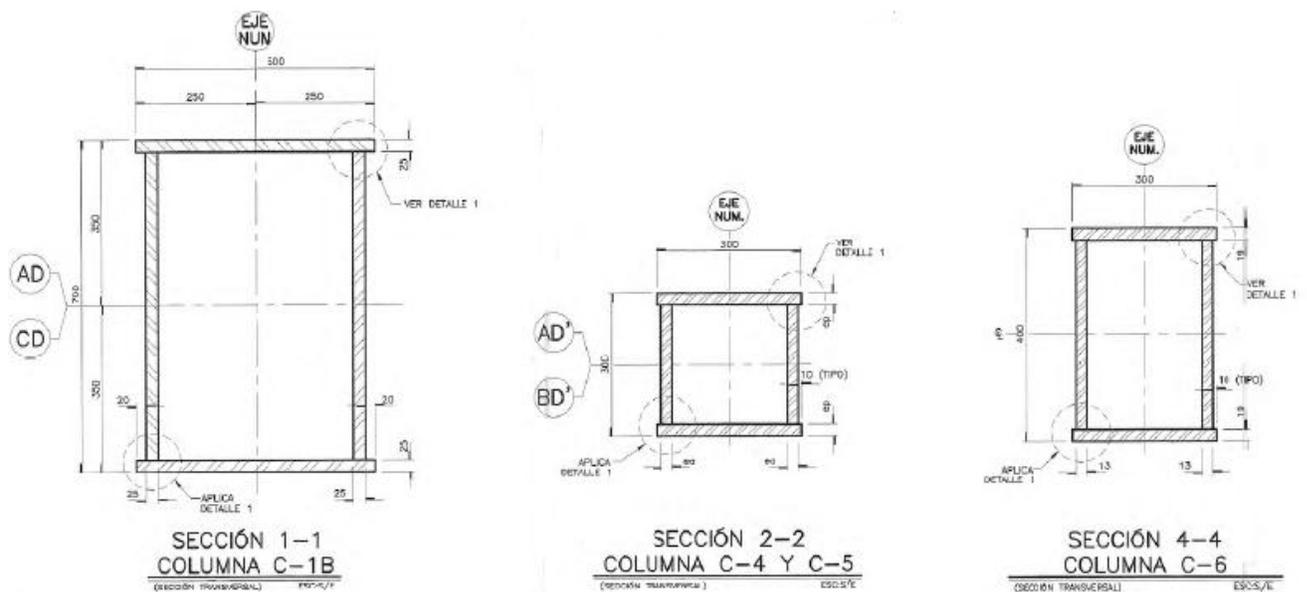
Sección de columnas tipo cajón principales C-1B y c-6, secundarias c-4 y c-5.
